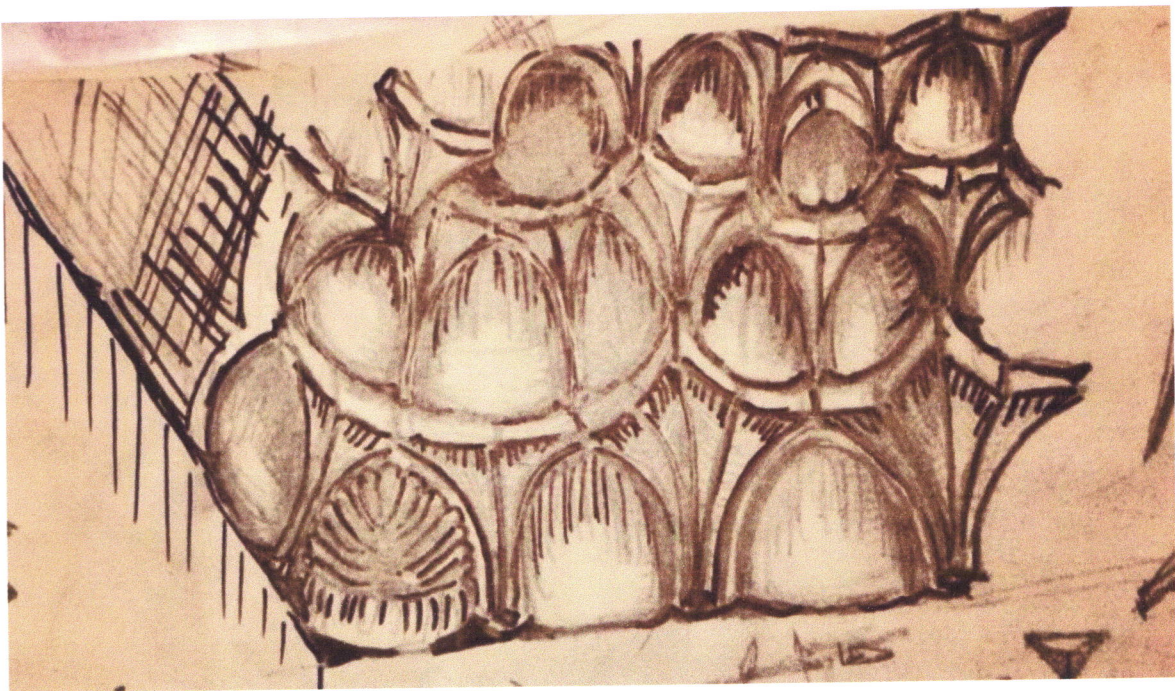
vue cavalières de la coupole à Mouqarnas dessinée par l'auteur
